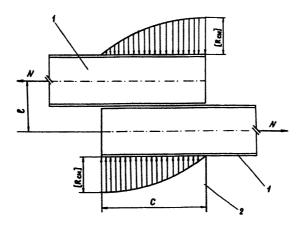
У.5. Расчетная схема перепуска элементов обвязочной балки в месте излома ее по высоте:
